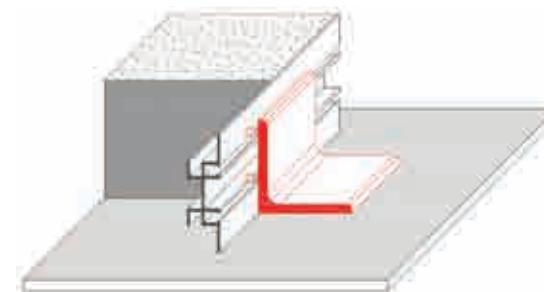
Elementos de fijación del perfil perimetral a la mesa de hormigonado
